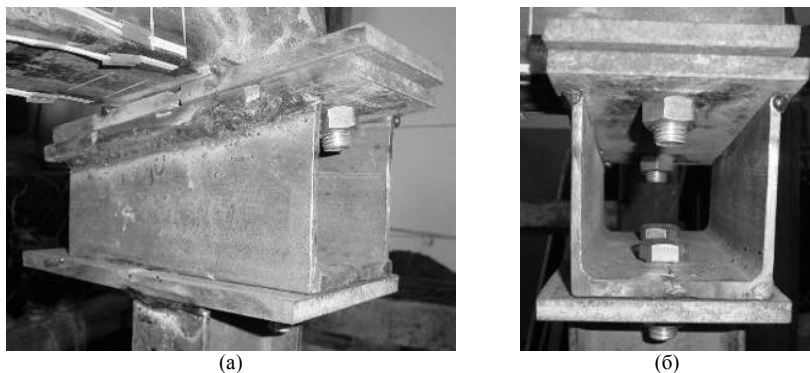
Конструкція „башмаків” (а) – вигляд збоку; (б) – вигляд спереду
